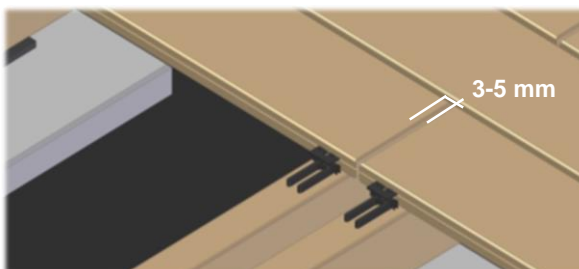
Skru endeklipset fast til underkonstruksjonen.
